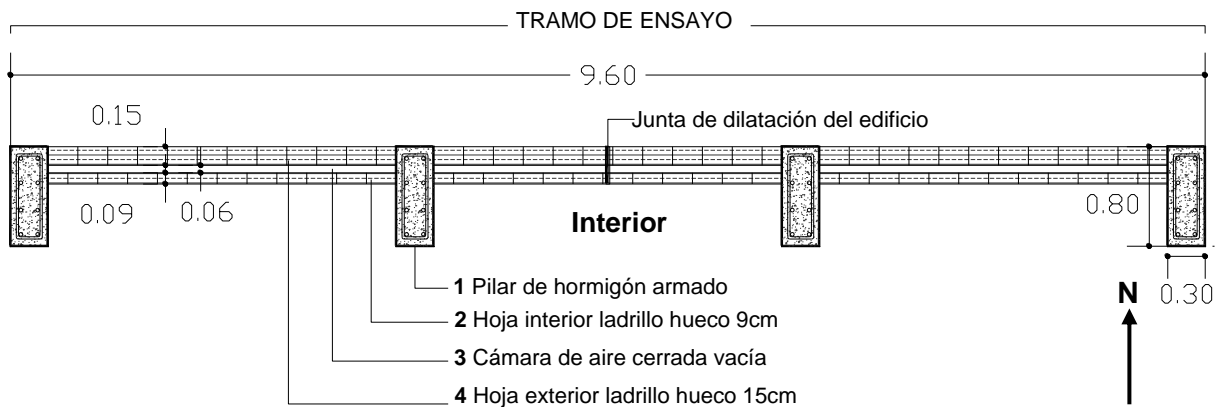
Detalle en planta del tramo de ensayo (D')
